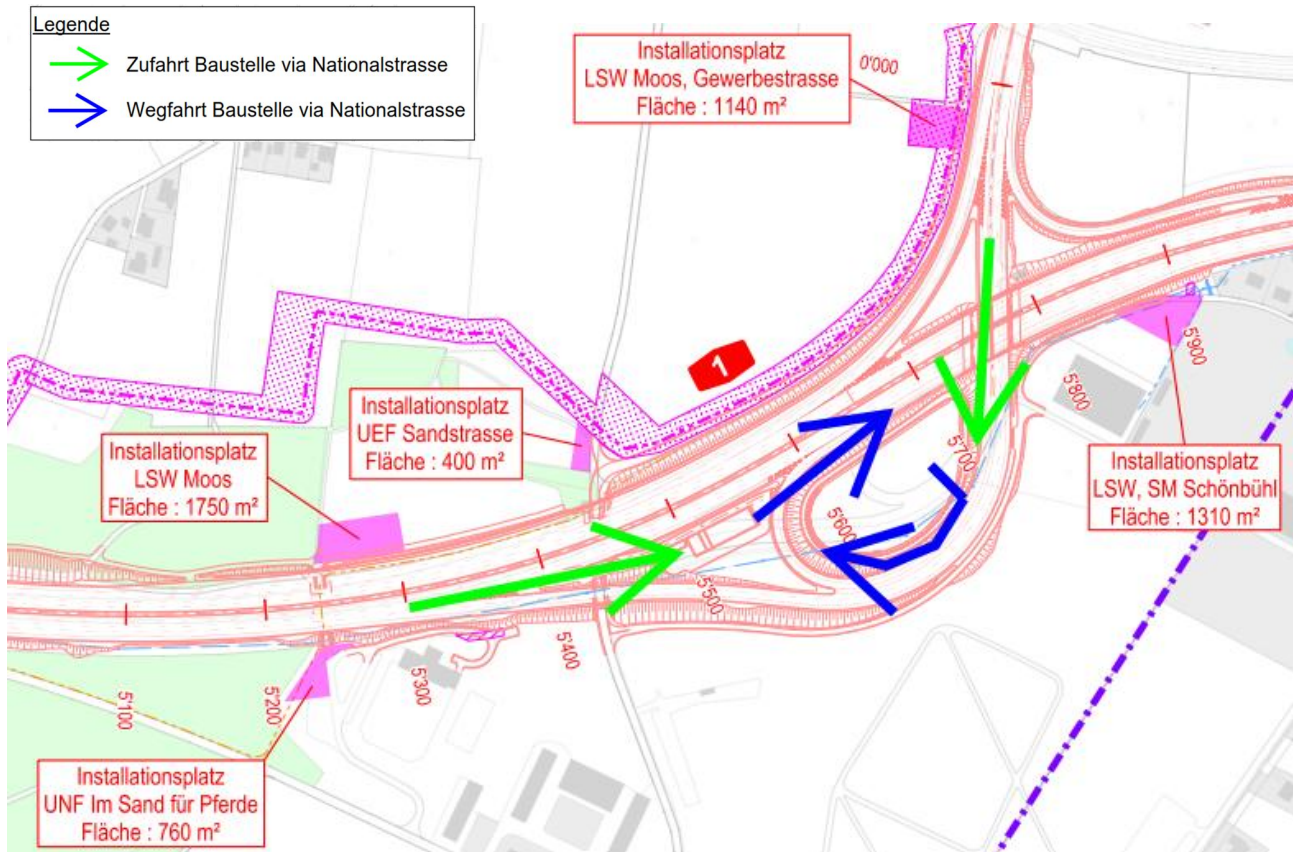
Erschliessung Baustelle SABA Schönbühl
